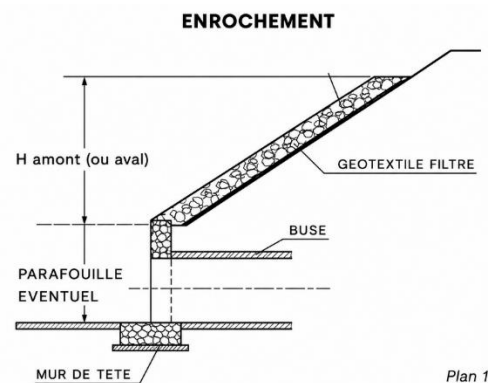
Dispositif d'enrochement et de parafouille au droit d'une buse
